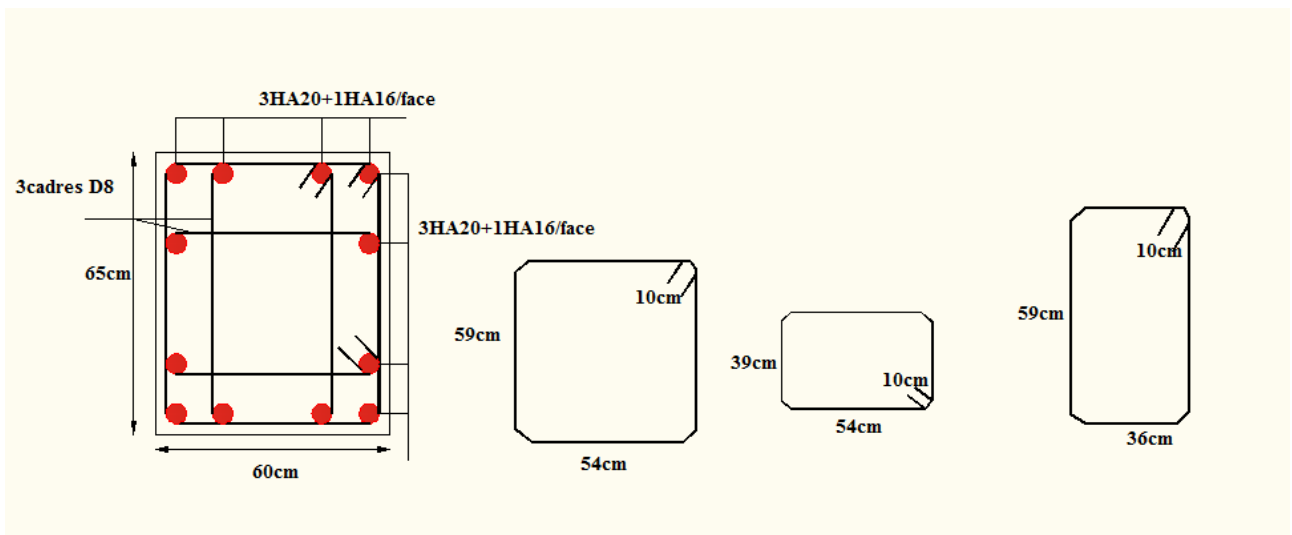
Schéma de ferrailage des poteaux d'étage 6
